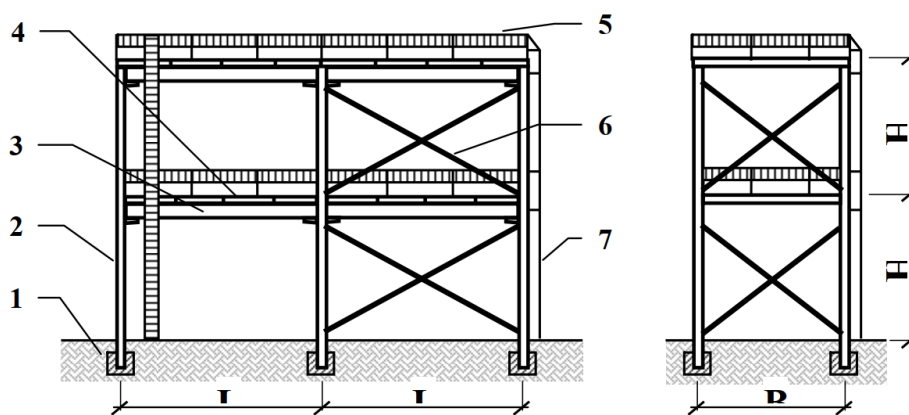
Етажерка для технологічного обладнання ($L = 4500, 6000, 9000$; $B = 4500, 6000$): 1 – фундамент; 2 – опора; 3 – балка; 4 – плити перекриття; 5 – огороження; 6 – зв’язки; 7 – сходи
